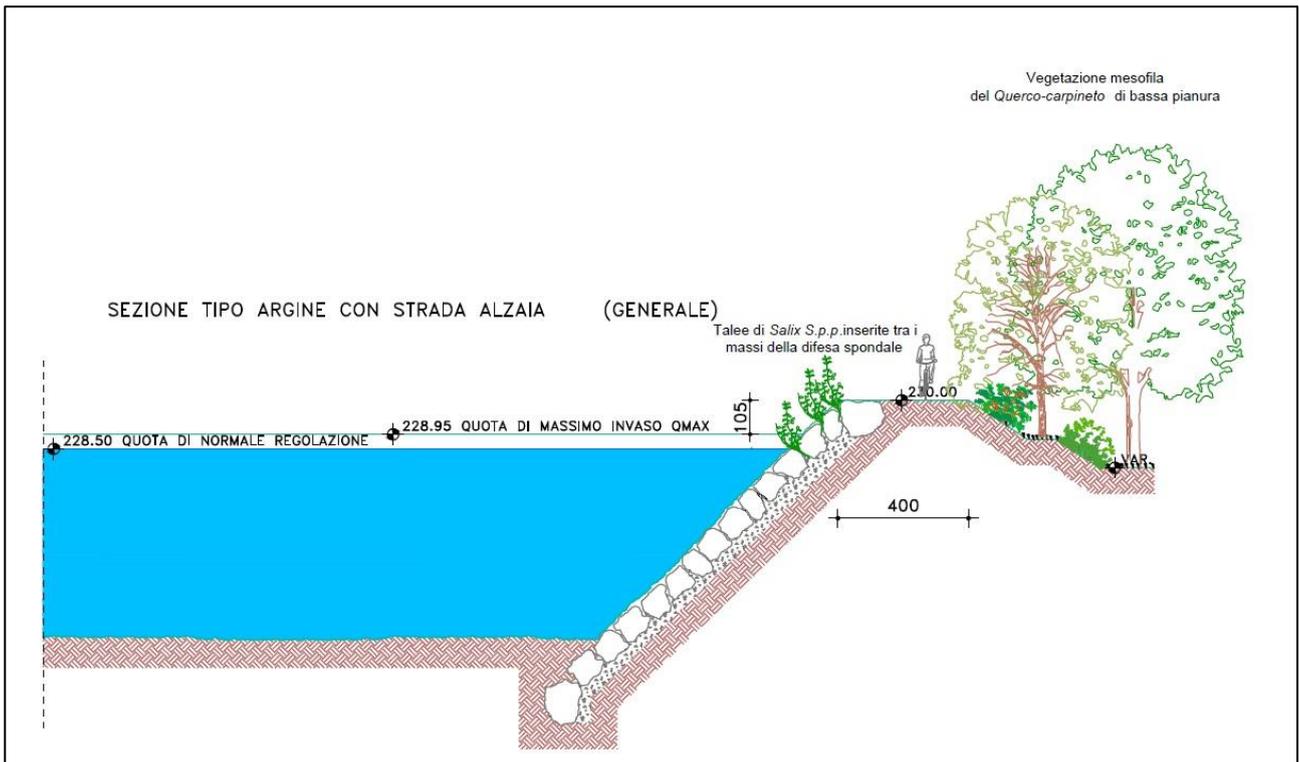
SEZIONE TIPO DEI RINVERDIMENTI DELLE DIFESE SPONDALI CON STRADA ALZAIA DI NUOVA COSTRUZIONE
